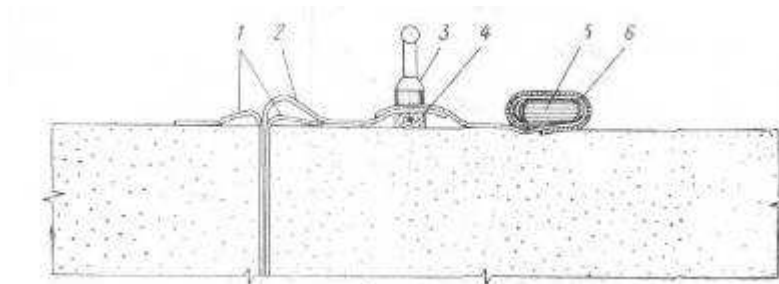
Сварка рабочих полотнищ пленки на месте укладки
